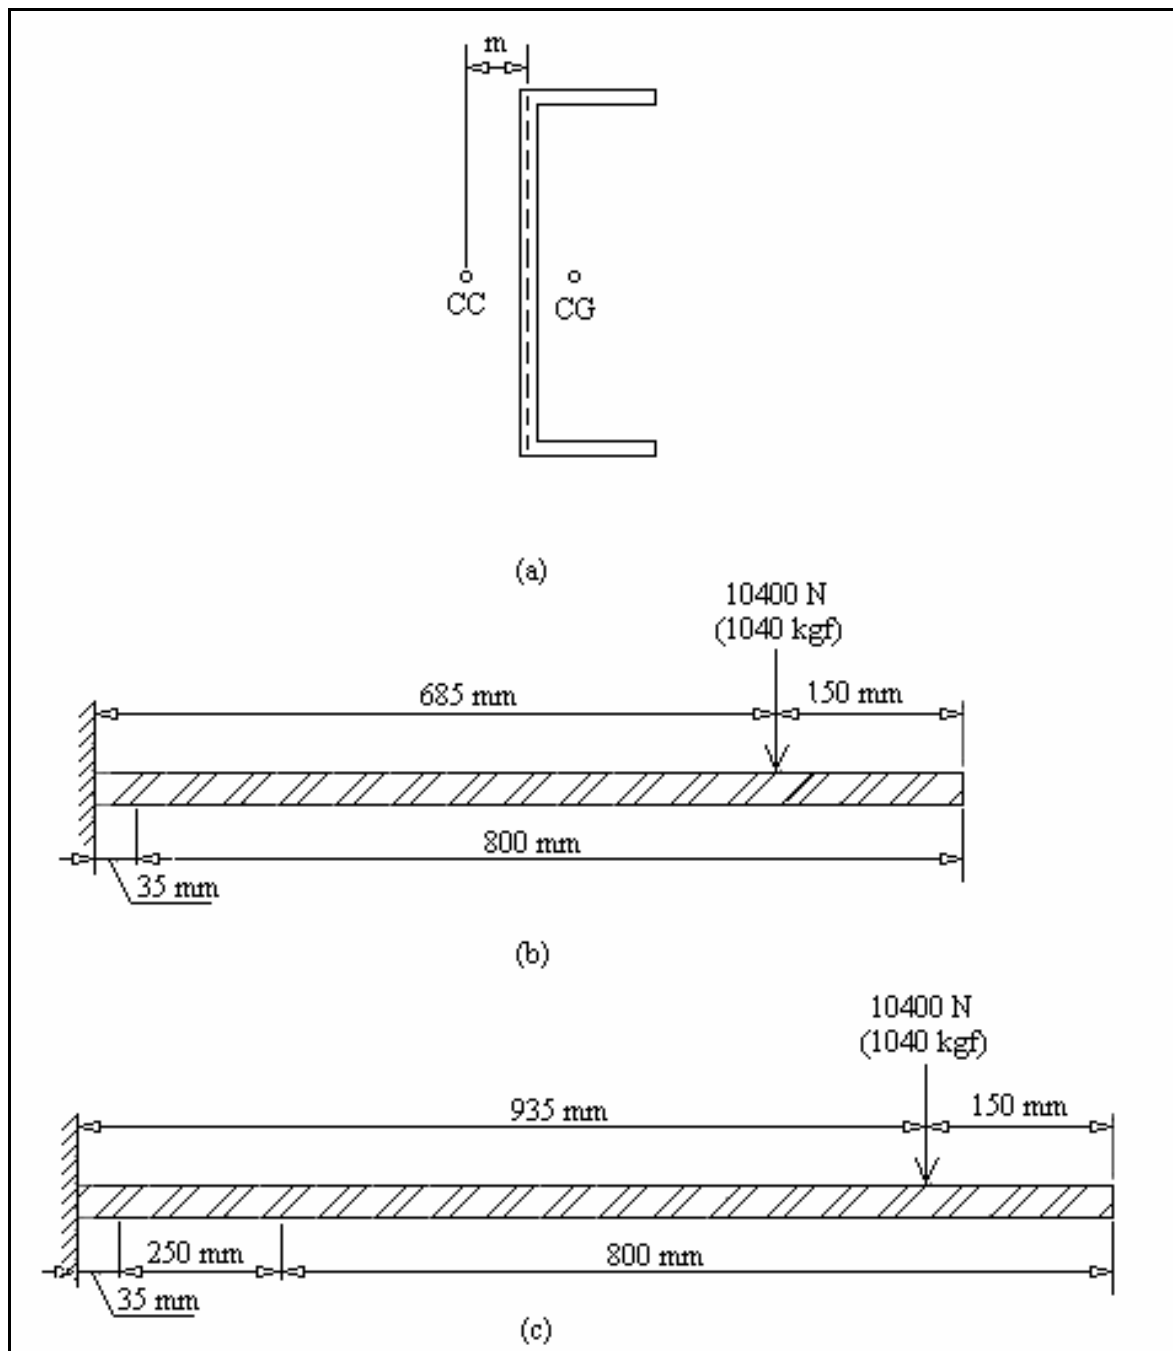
Definição dos carregamentos adotados para a vigas tipo 1 e 2.
